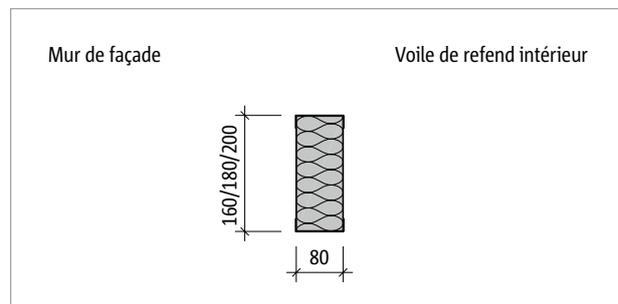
Schöck Rutherma® T type RF-Z : vue en plan
